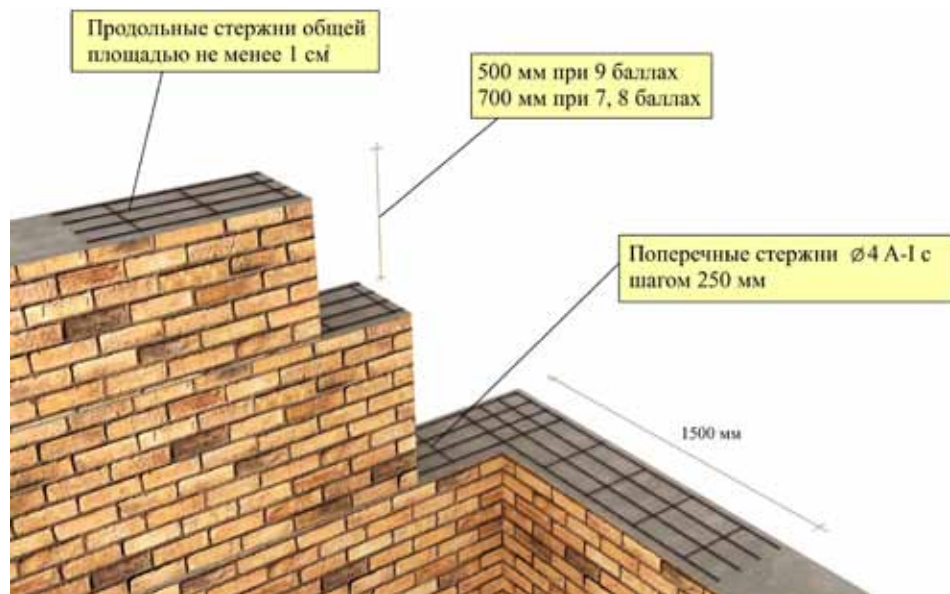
Армирование кирпичной кладки в сопряжениях наружных стен
